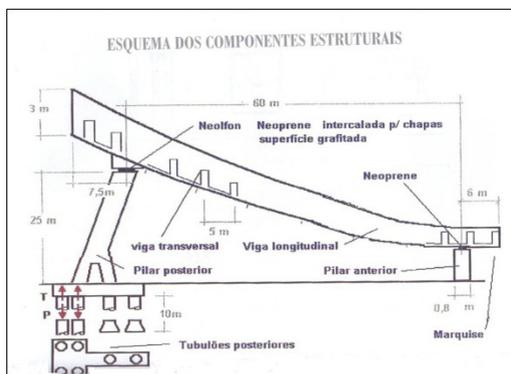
Esquema dos componentes estruturais da construção da catedral.
